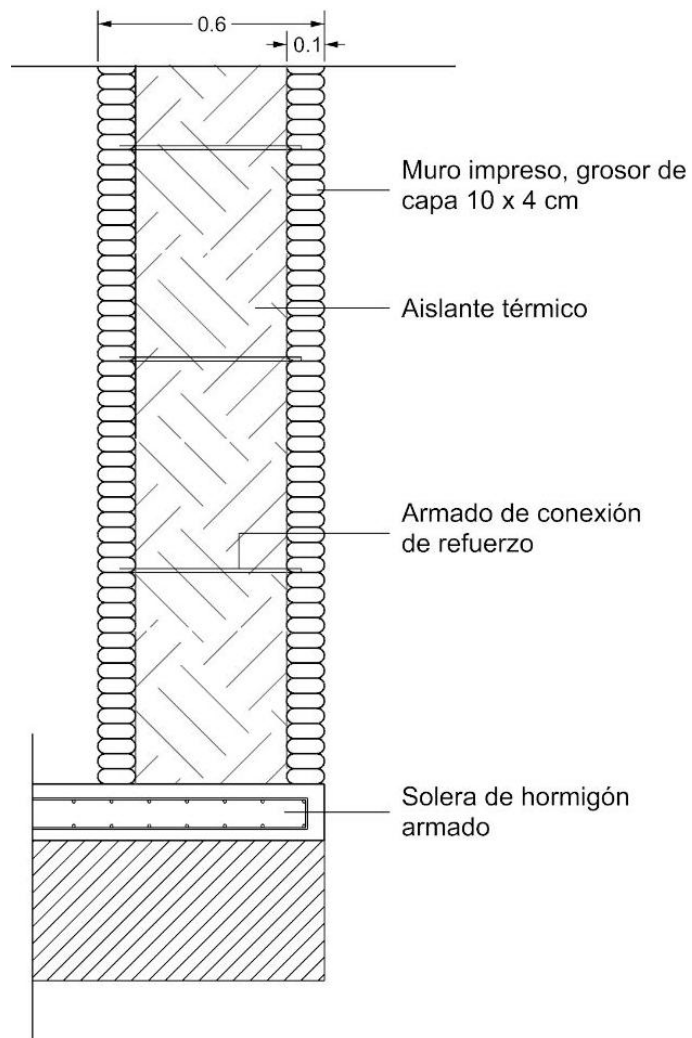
Detalle sección vertical muro, construcción aditiva. E 1/20
